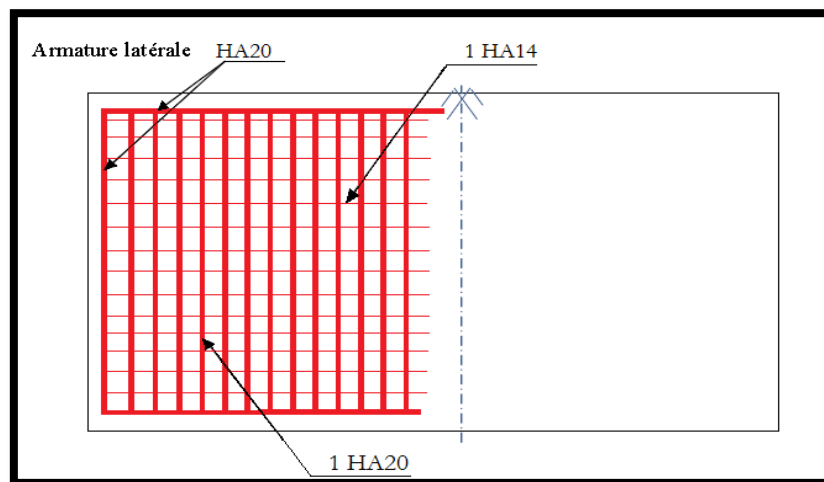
Ferrailage de la nappe supérieure de la semelle.
